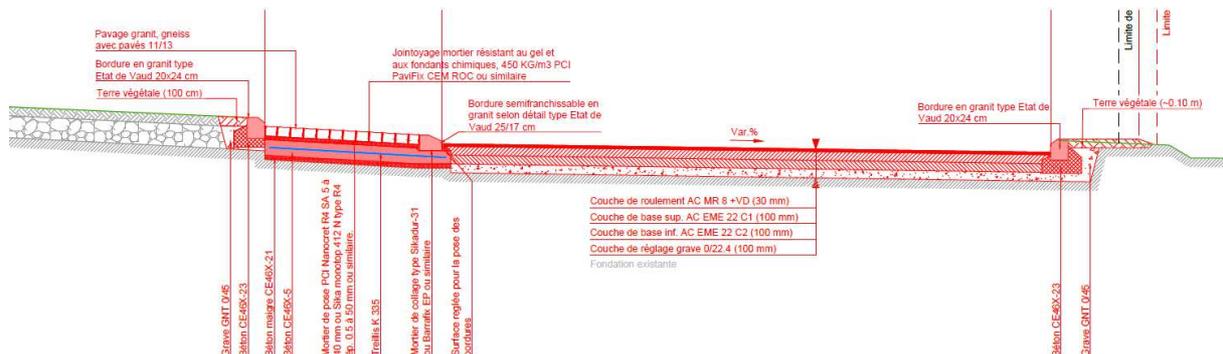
Profil type de l'anneau du giratoire de la Placette
